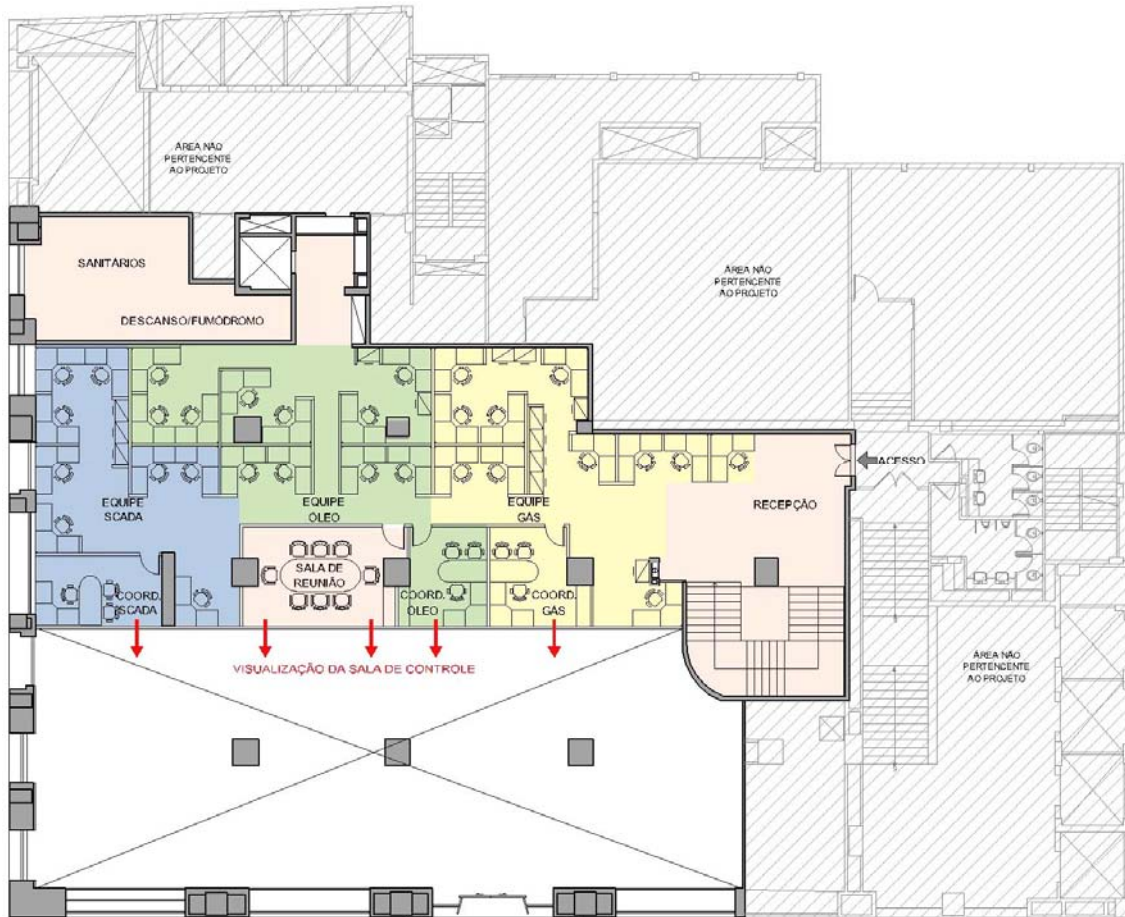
Planta baixa mezanino: primeiro estudo de layout (trinta e um de maio)
